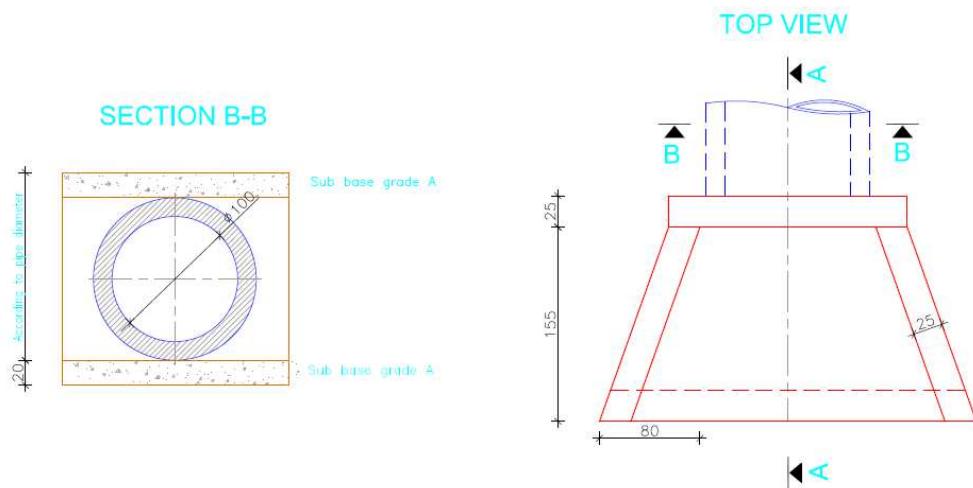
Vista de tubo de alcantarilla de Ø 100
